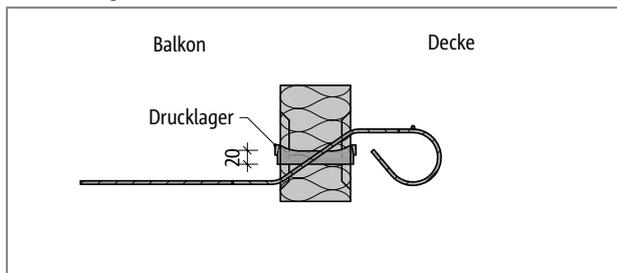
Schöck Isokorb® Typ QXT10 bis QXT40: Produktschnitt
